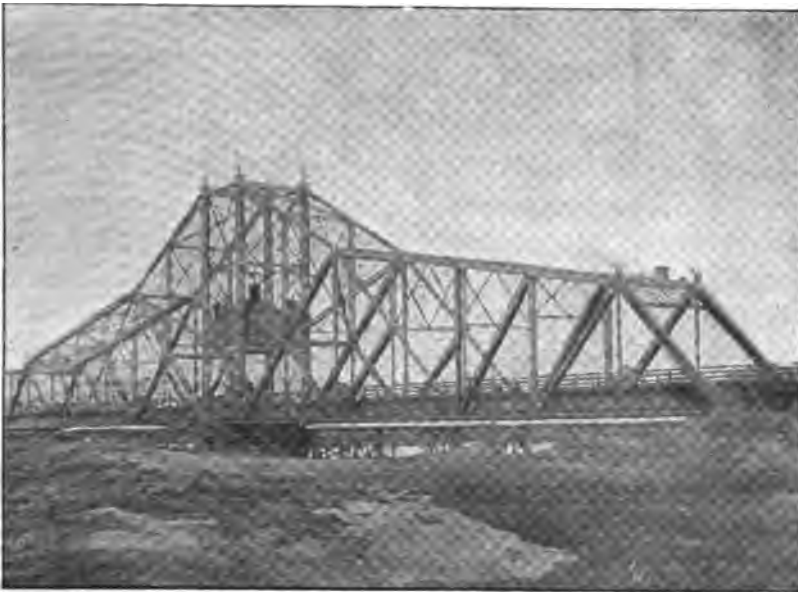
Travée tournante de 158^m,60 de l'Interstate Bridge, à Omaha.
